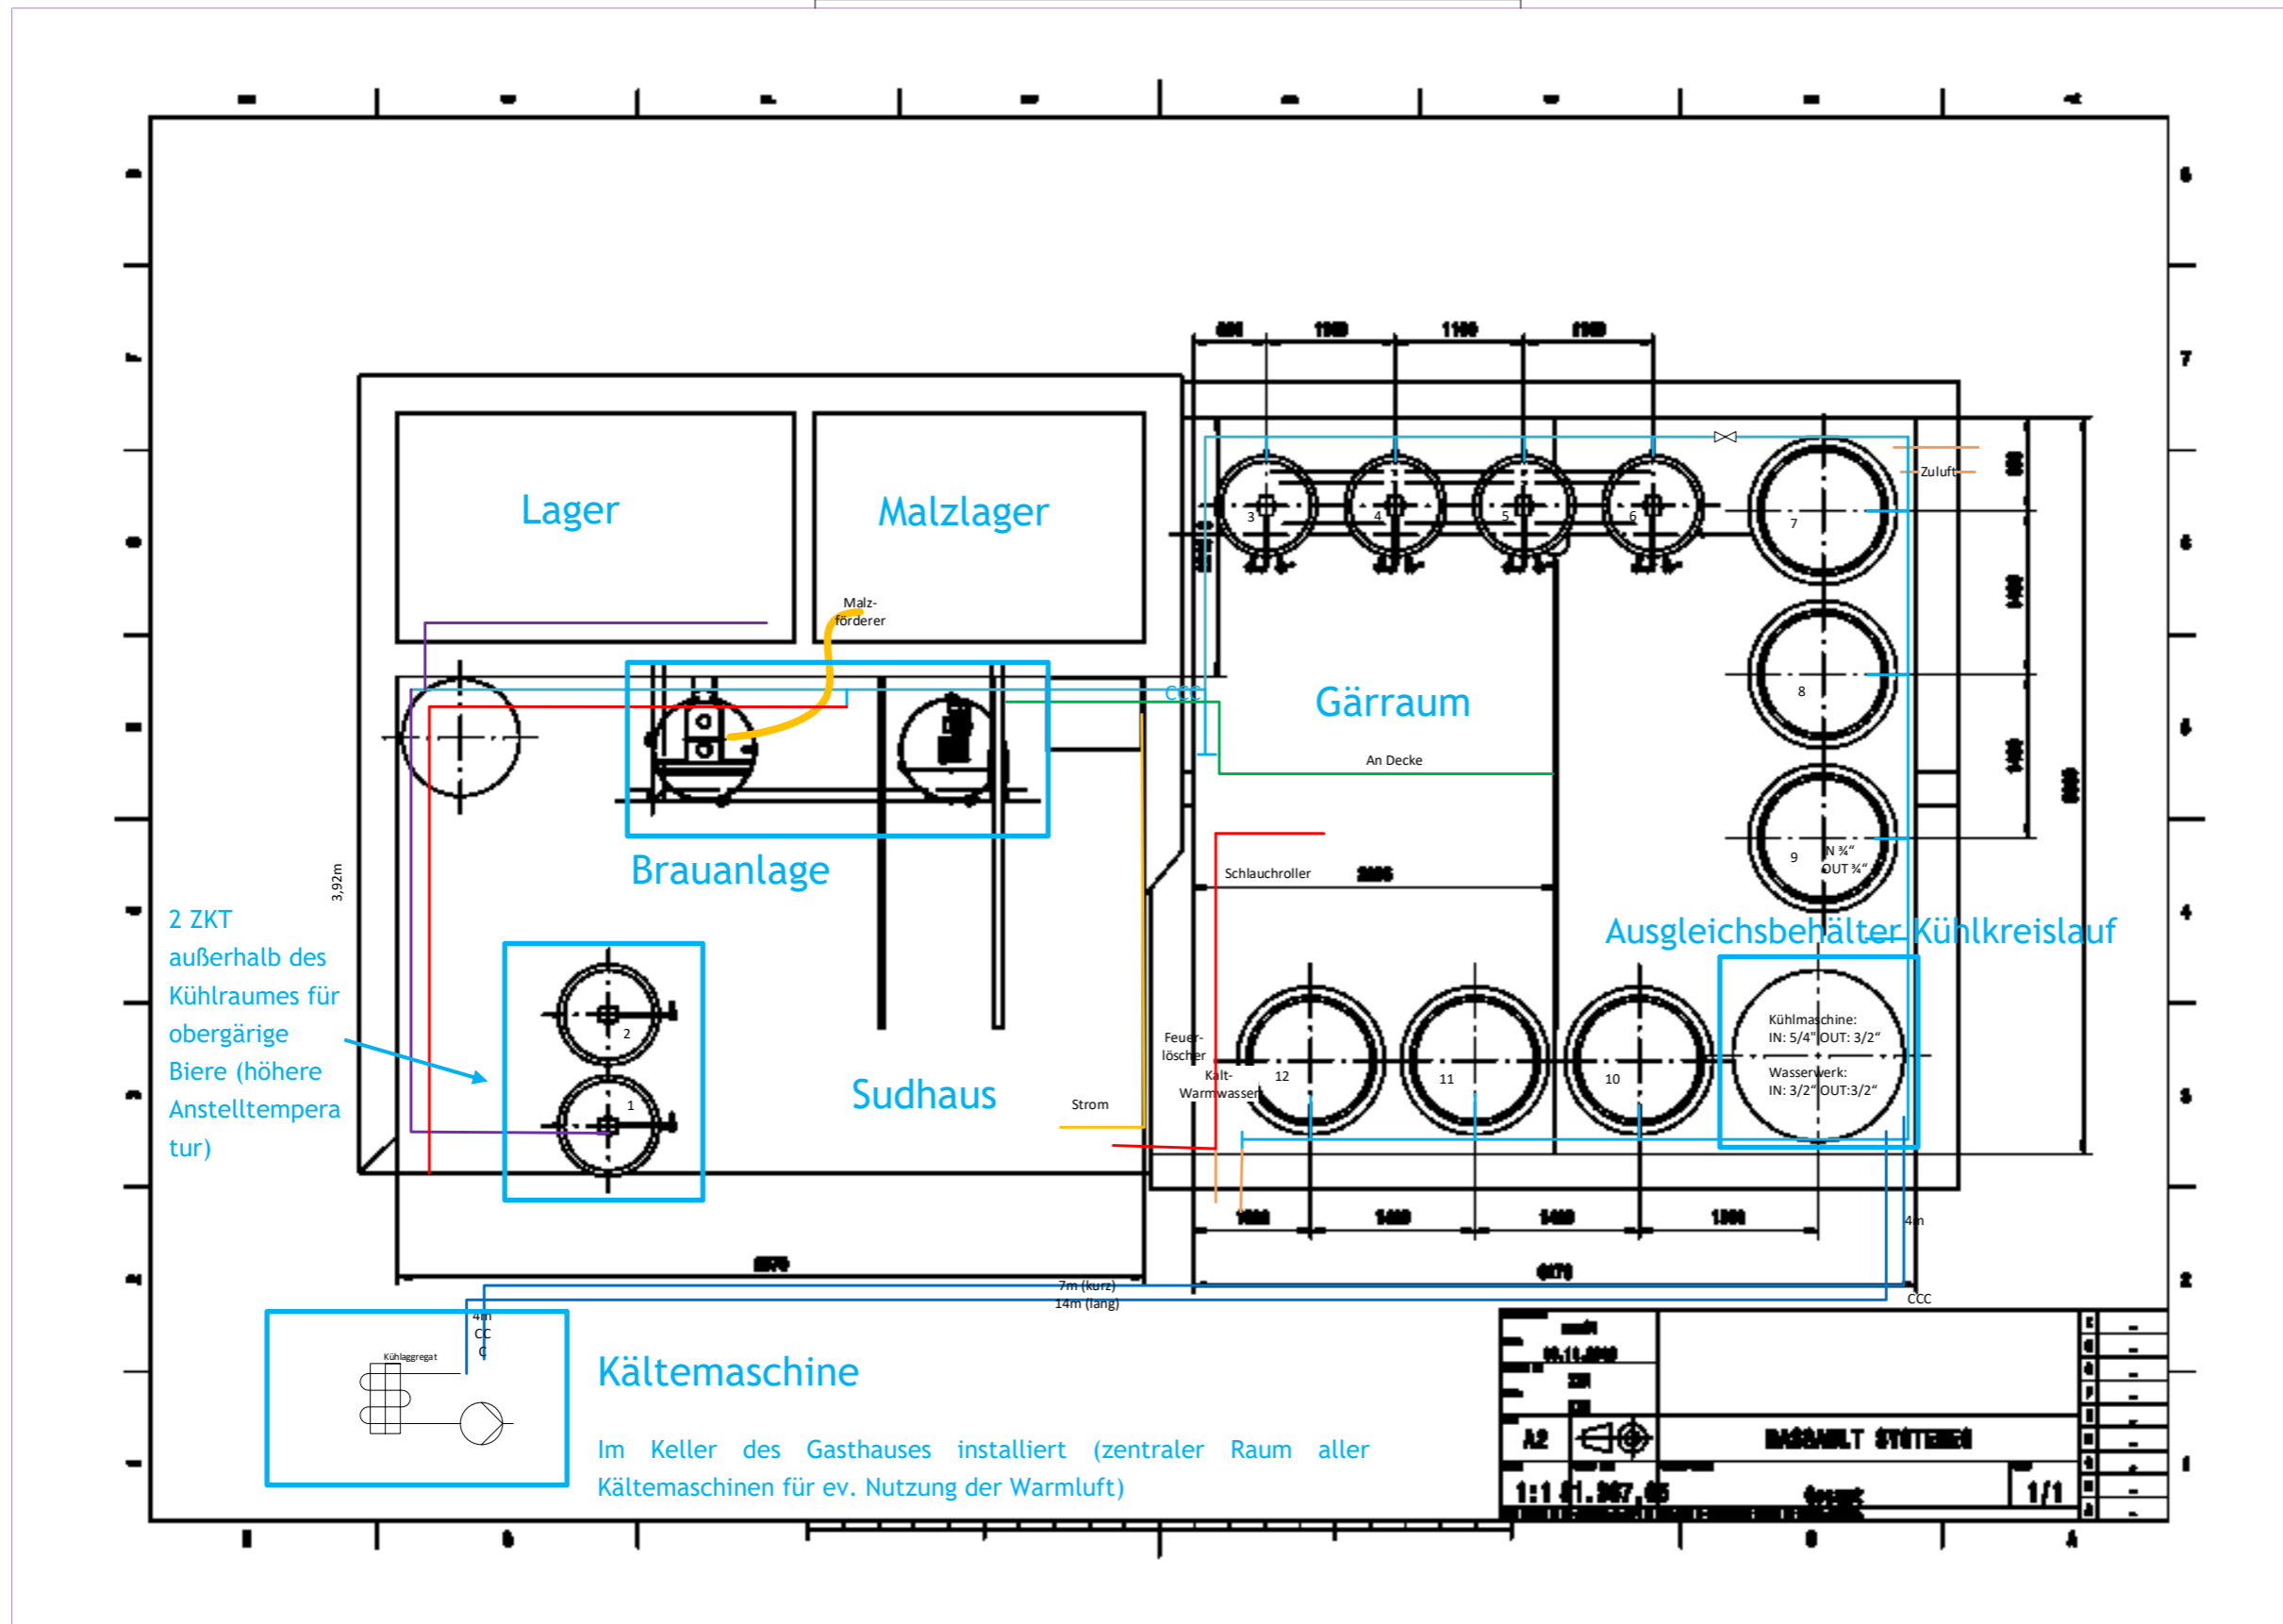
Grundriss Brauerei + Kühlraum
